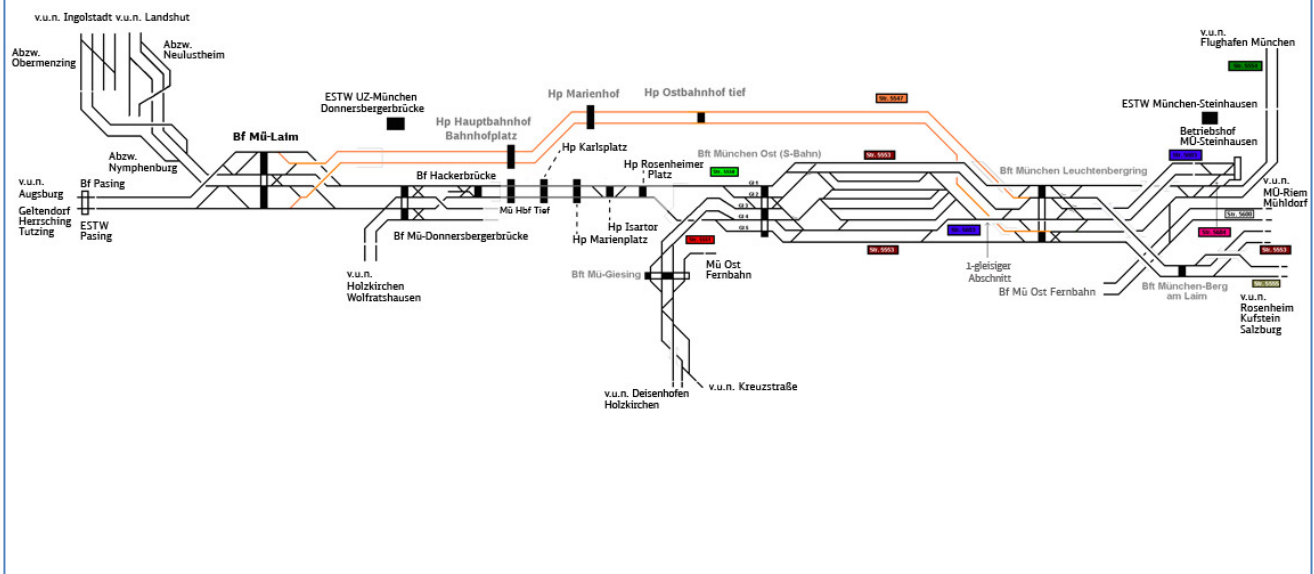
Spurplan 2. S-Bahn-Stammstrecke Quelle: <https://www.2.stammstrecke-muenchen.de/>
